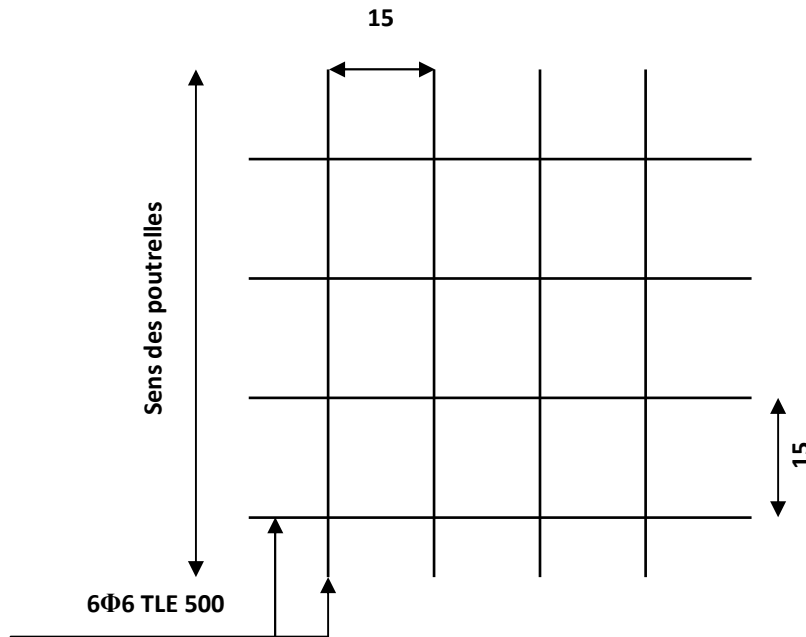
Ferrailage de la dalle de compression avec un treillis soudé
